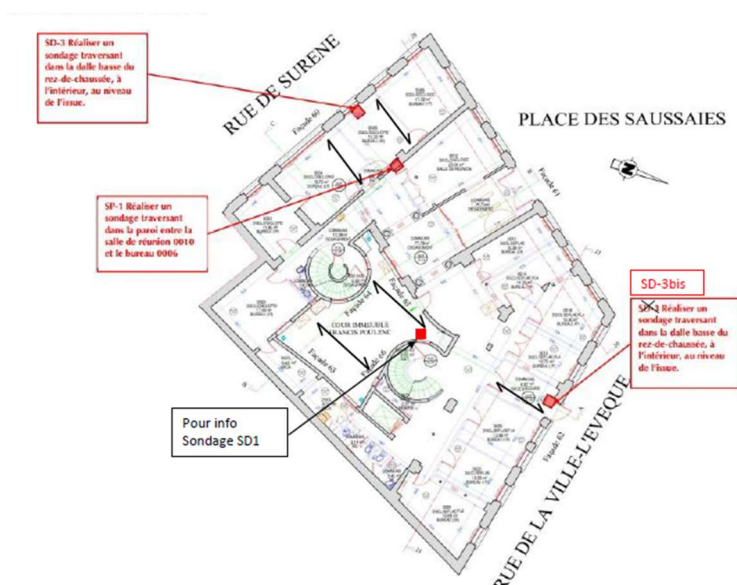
Repérage des sondages sur plancher bas RDC. Rapport Rincet BTP
